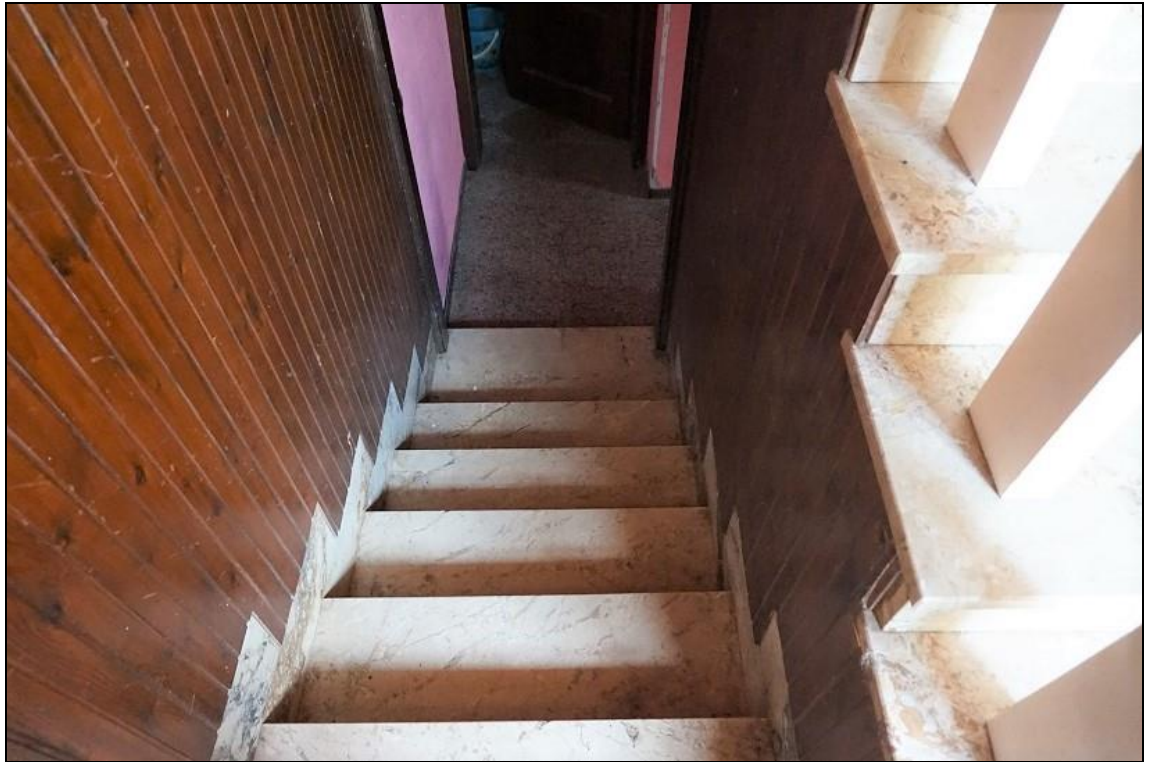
Piano seminterrato: scala di accesso da piano terra
